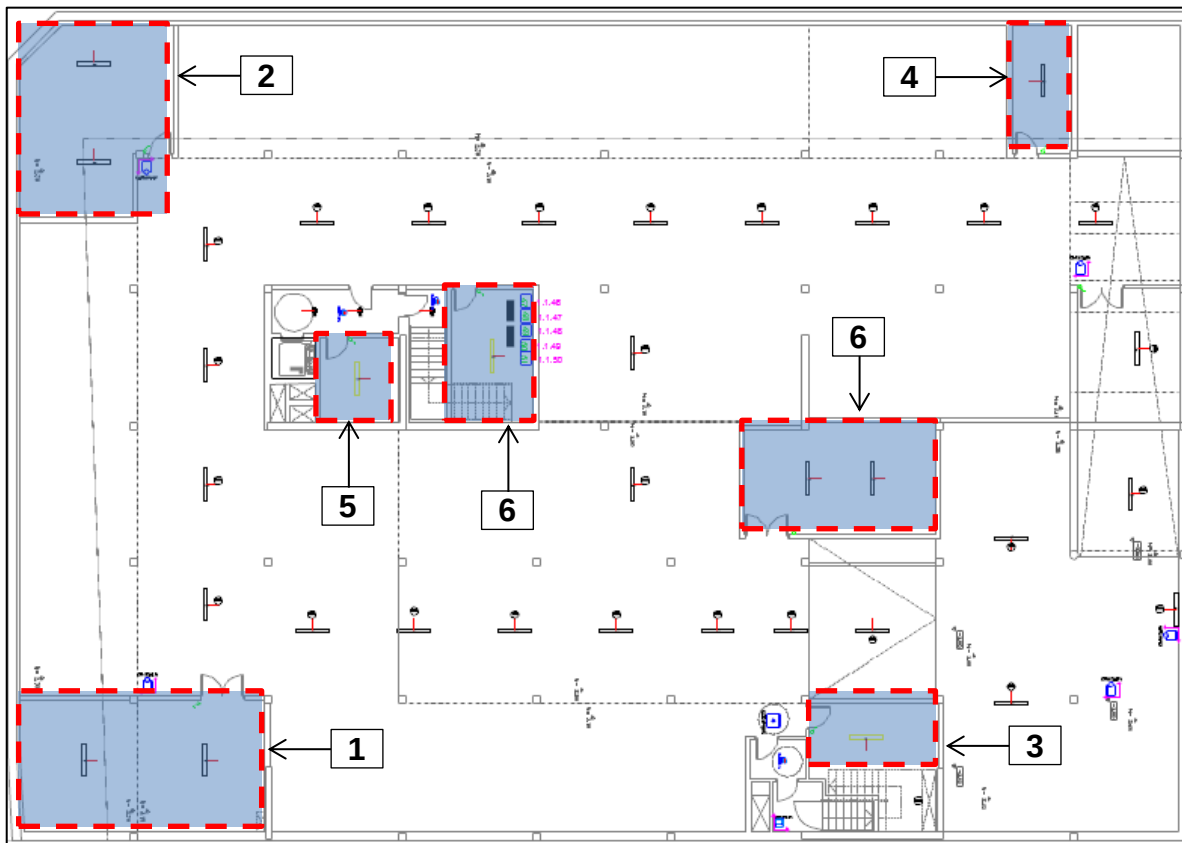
Planta de Garaje. Ubicación de Salas sin control
